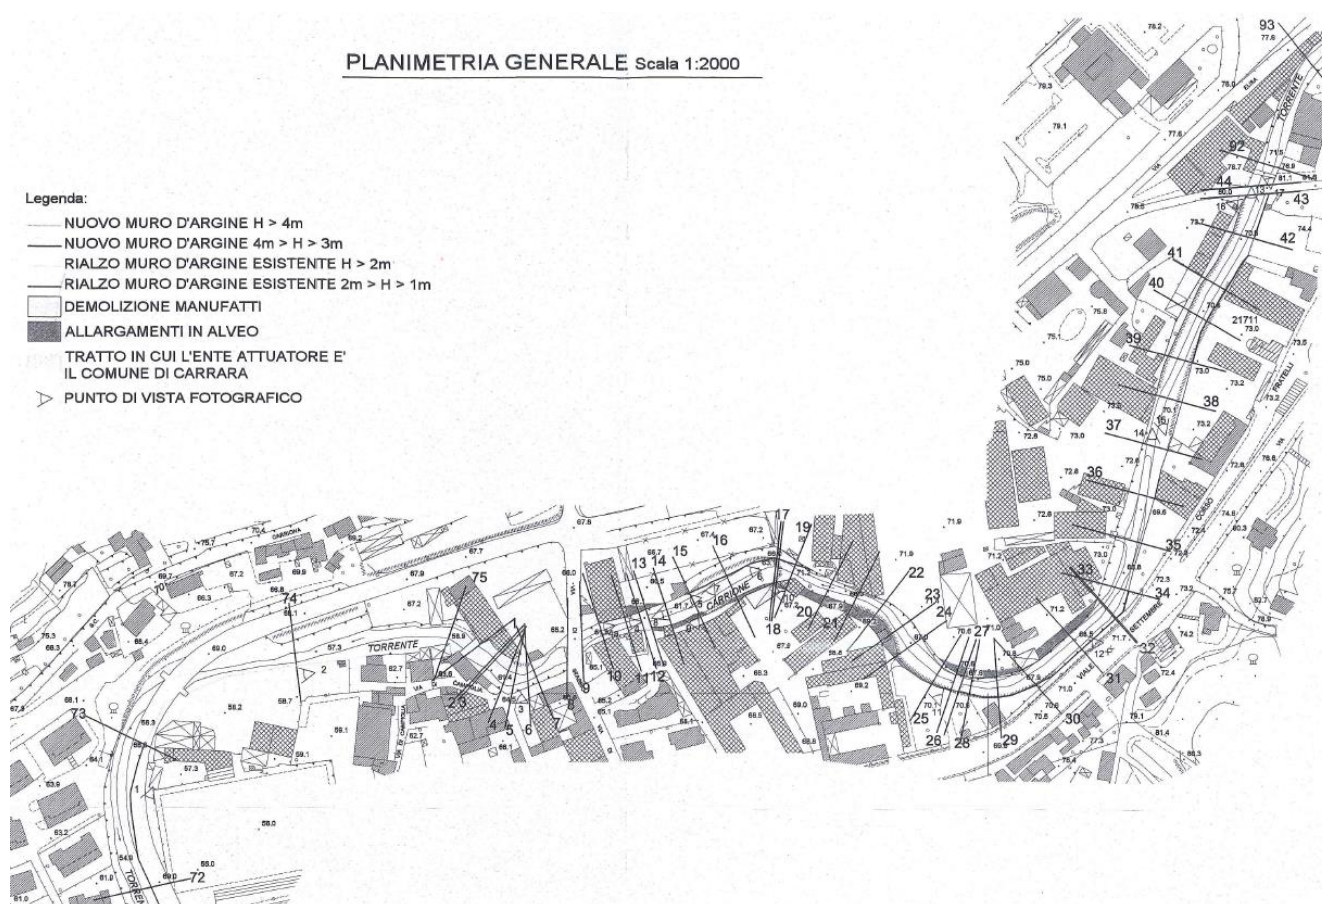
Estratto Planimetria interventi – P.S. N. 802/2013
